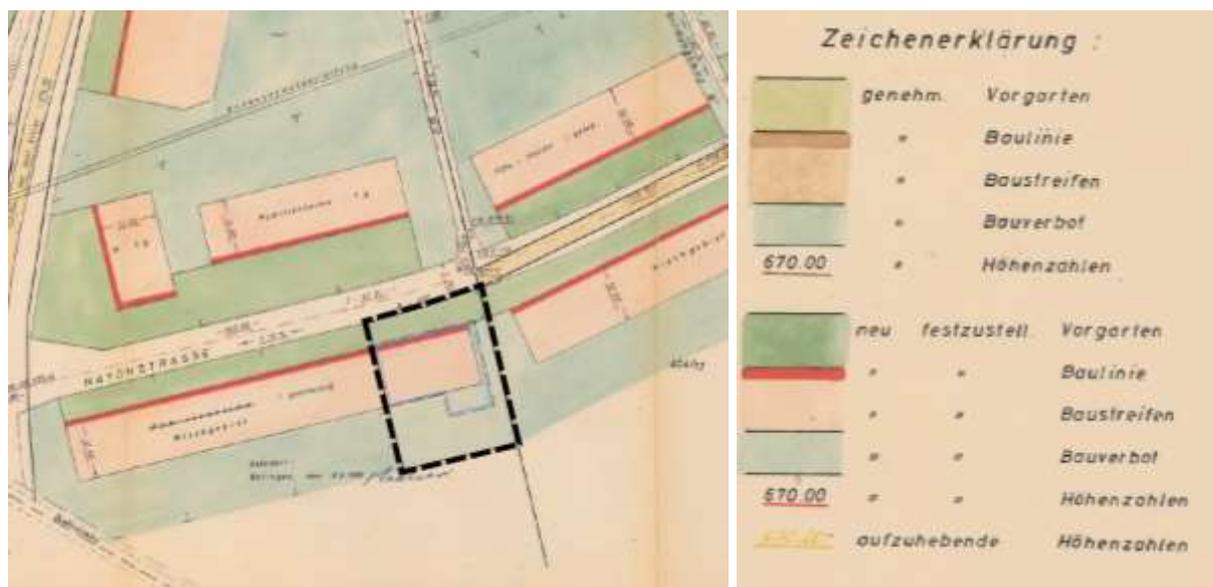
Baulinienplan von 1961 mit der Darstellung des Geltungsbereichs und der Baugrenze aus dem Bebauungsplan „Wasen II, 3. Änderung“
